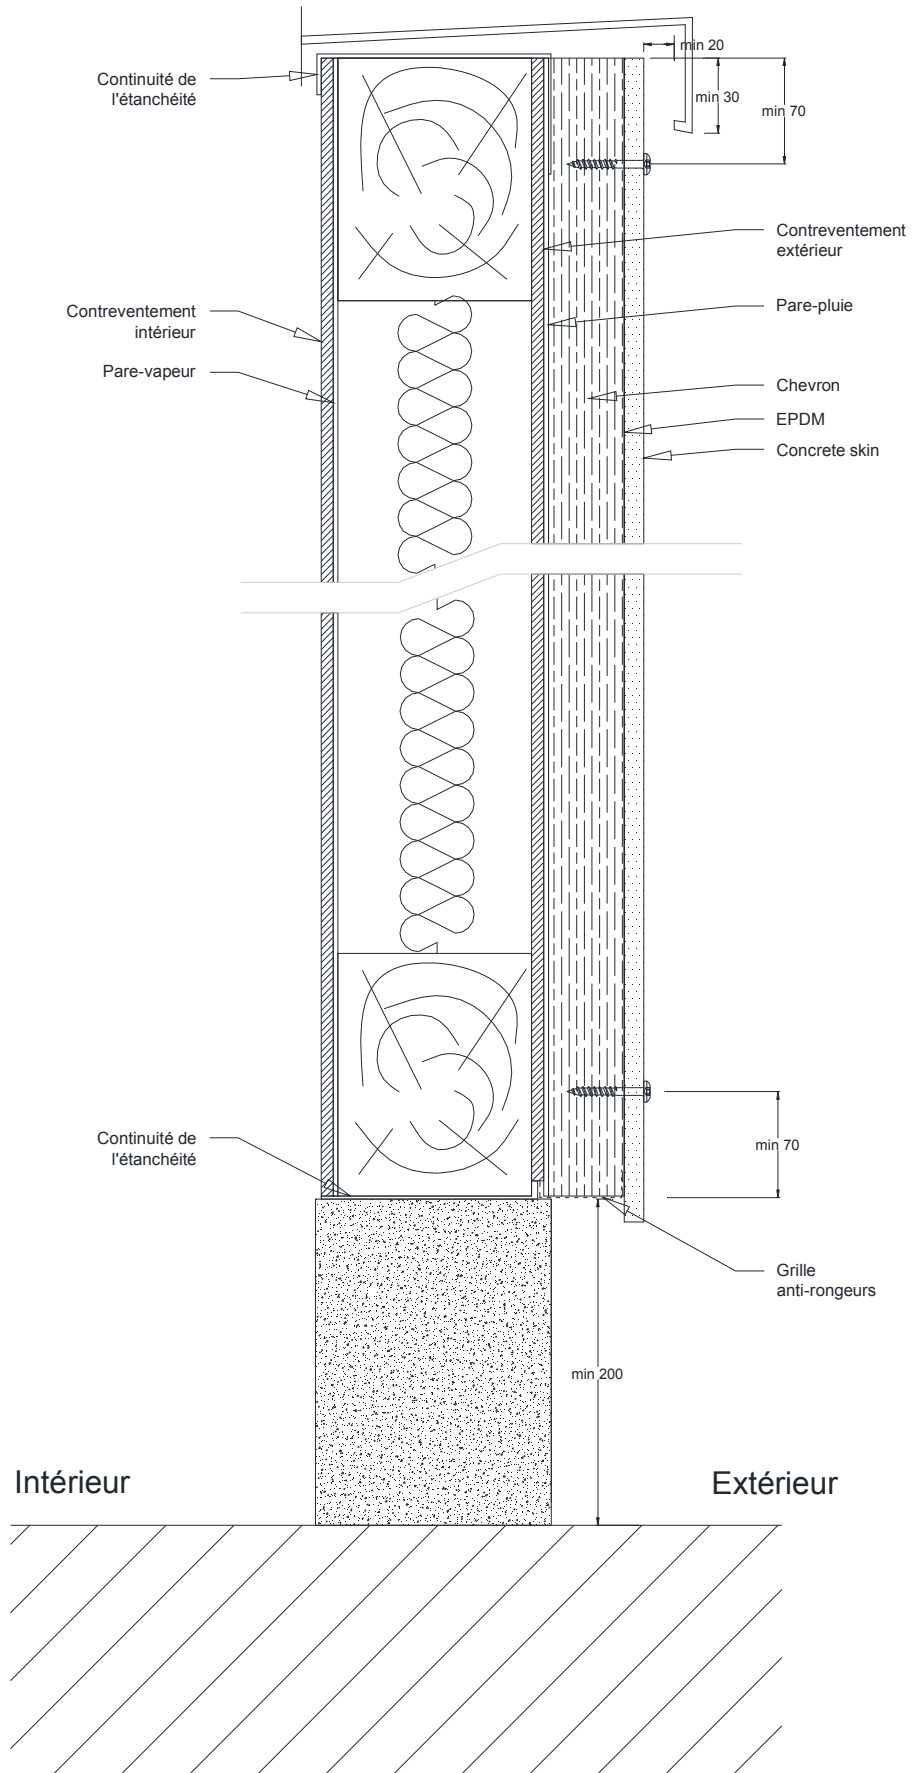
Pose sur COB – Coupe verticale simple réseau
